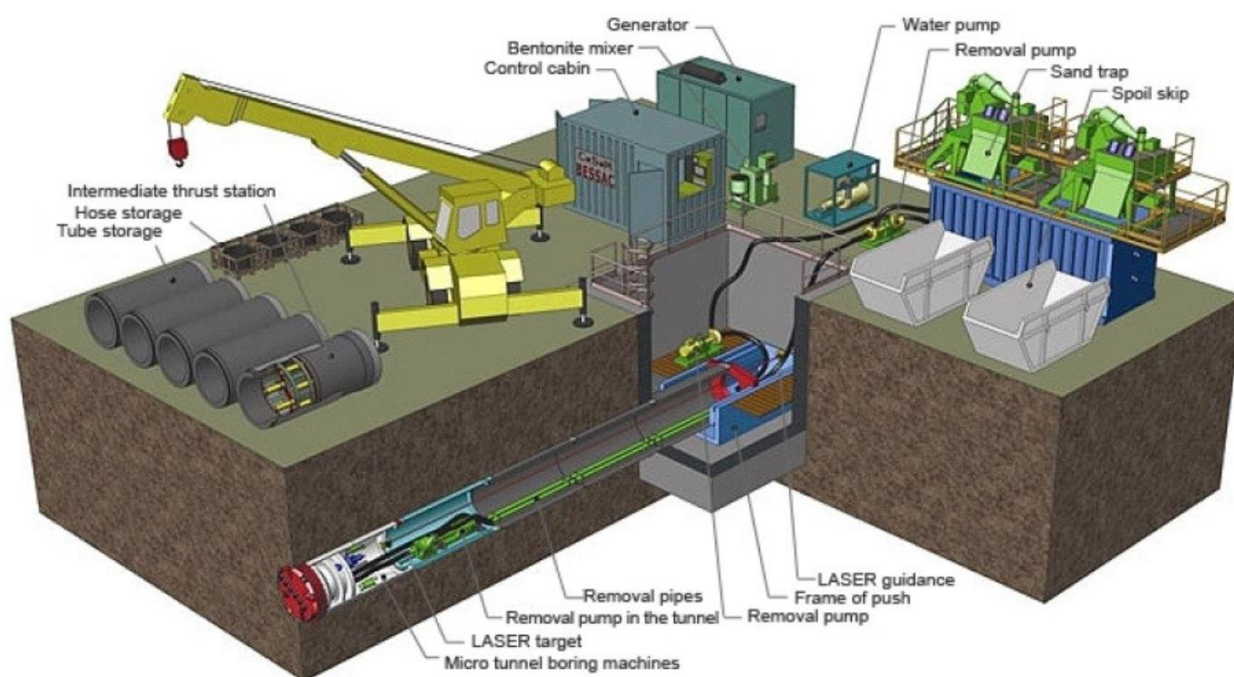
A : Schema tipo cantiere microtunnelling pozzo di spinta
